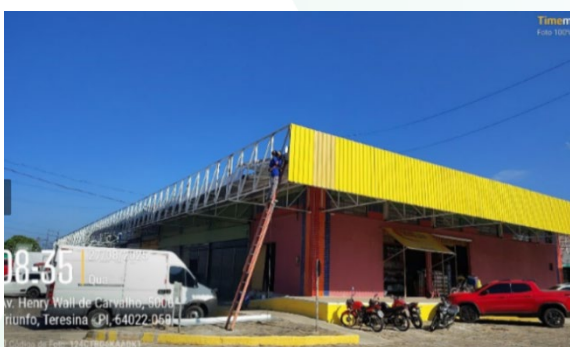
Instalação de treliças e barras metálicas pintadas na cor branca em fachadas e remoção da fachada antiga do galpão GP12-AMA.
